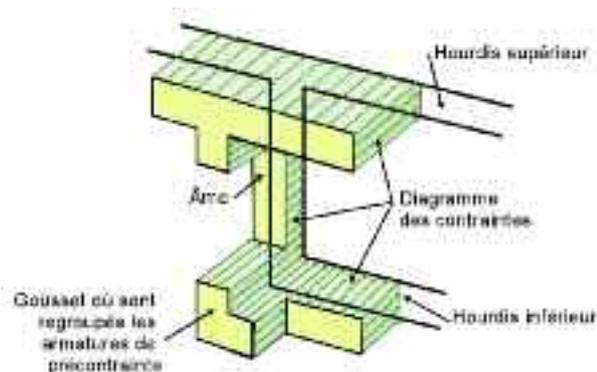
diagramme des contraintes constaté à cause d'un défaut de conjugaison au droit du joint entre deux voussoirs successifs
